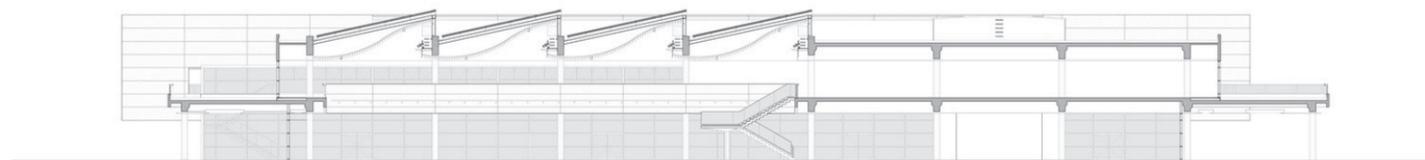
CORTE LONGITUDINAL > BIBLIOTECA DE SÃO PAULO
